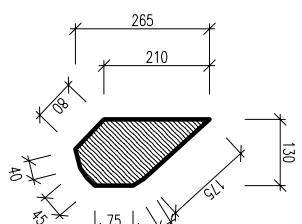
### DETAIL LEVÉHO JEZOVÉHO TĚLESA
